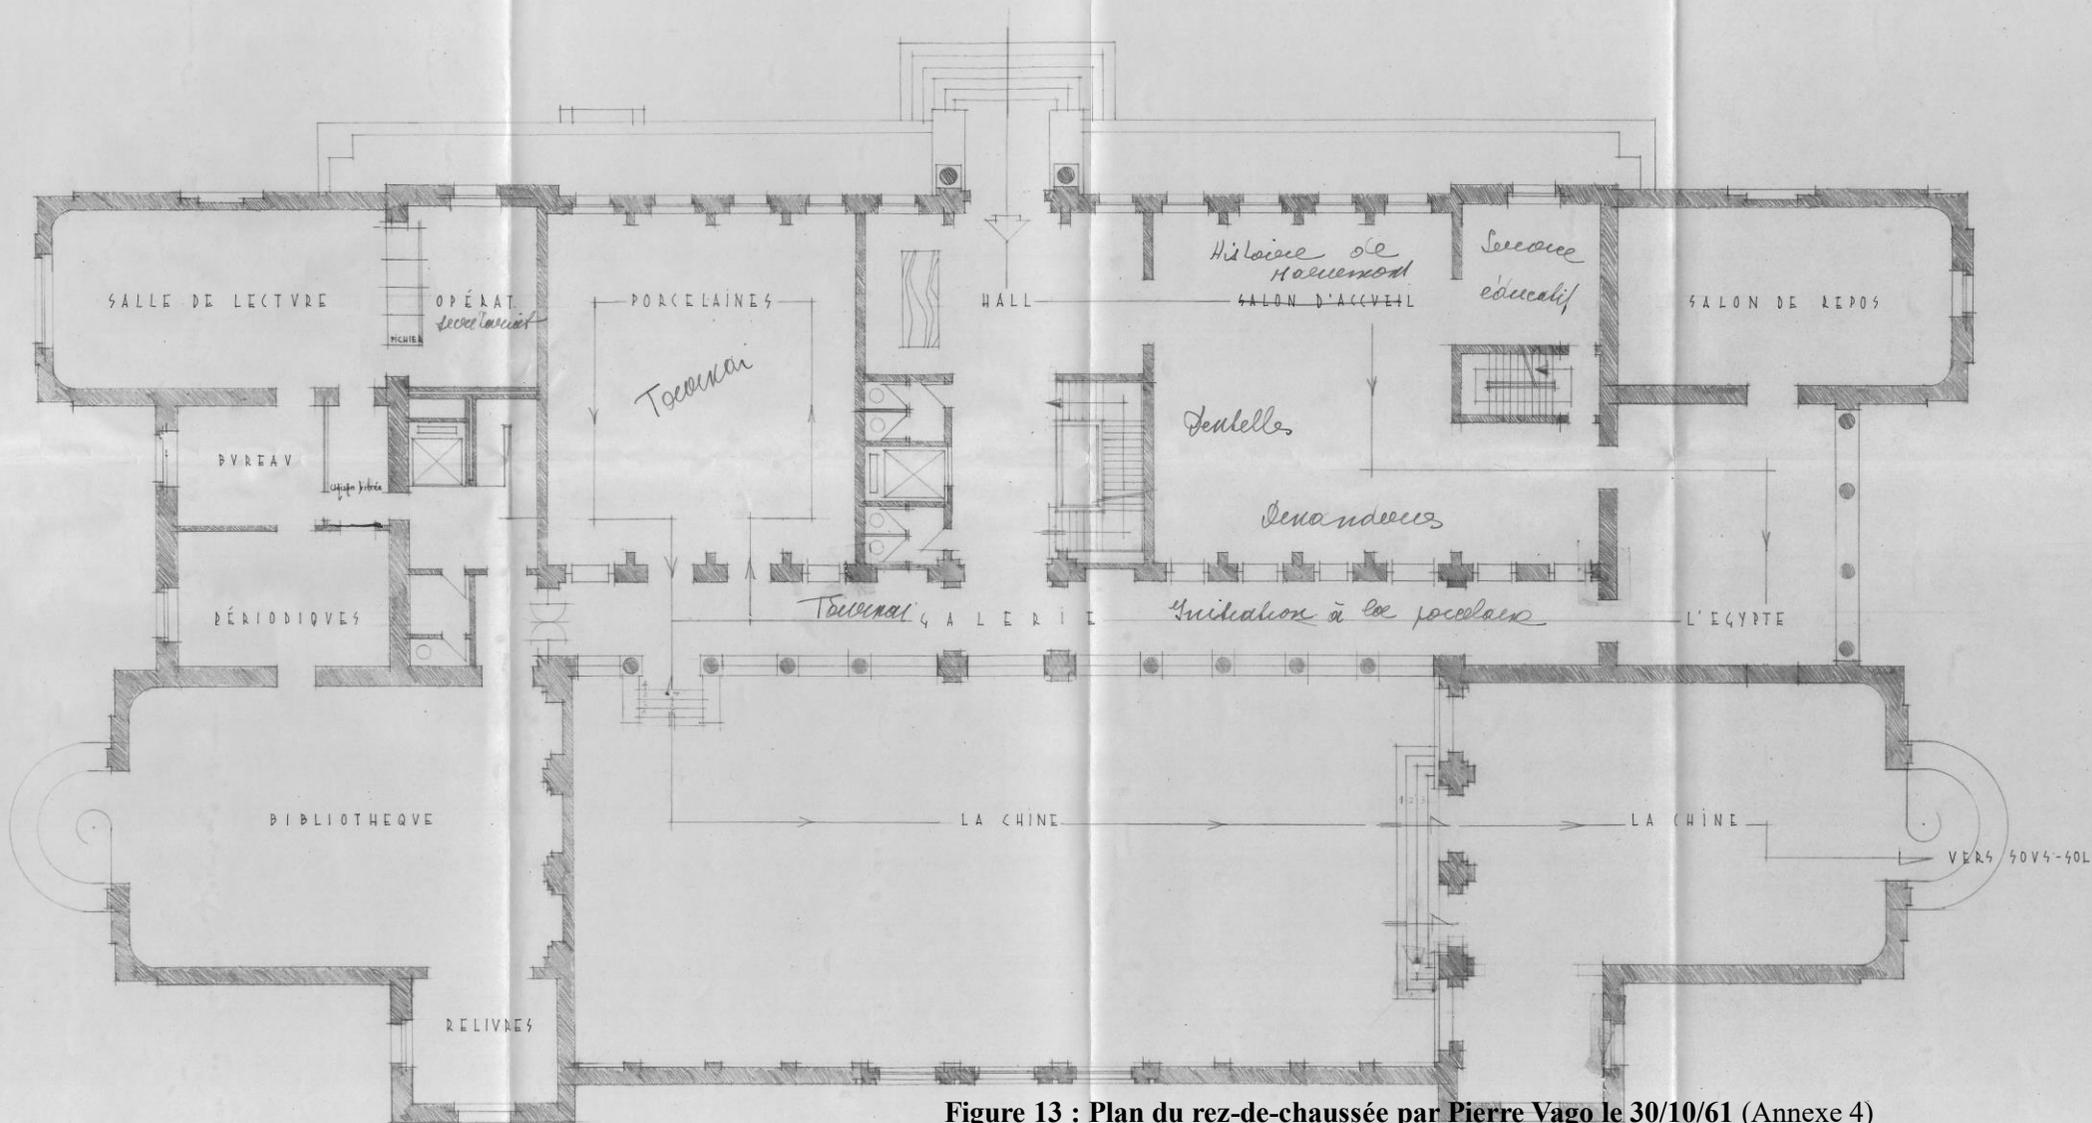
Plan du rez-de-chaussée par Pierre Vago le 30/10/61 (Annexe 4)
